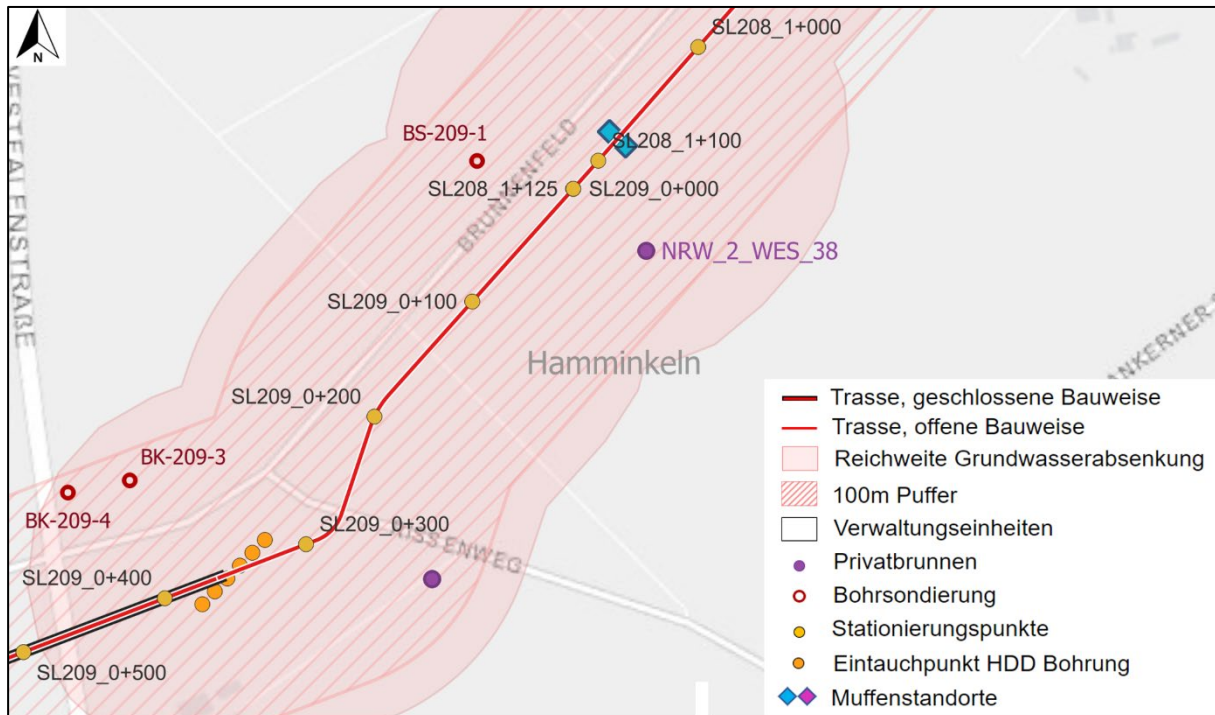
Lageplan Brunnen NRW_2_WES_38
